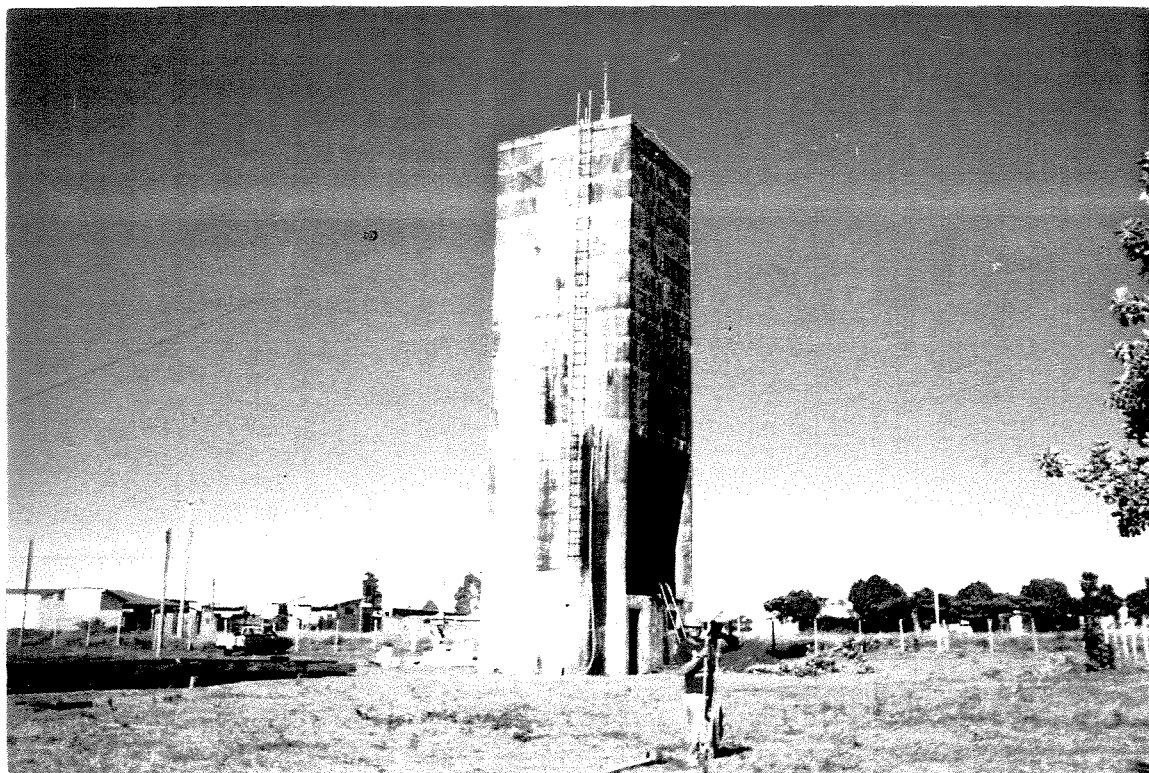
Construção fora de sua verticalidade original por problemas de recalque de fundação.
